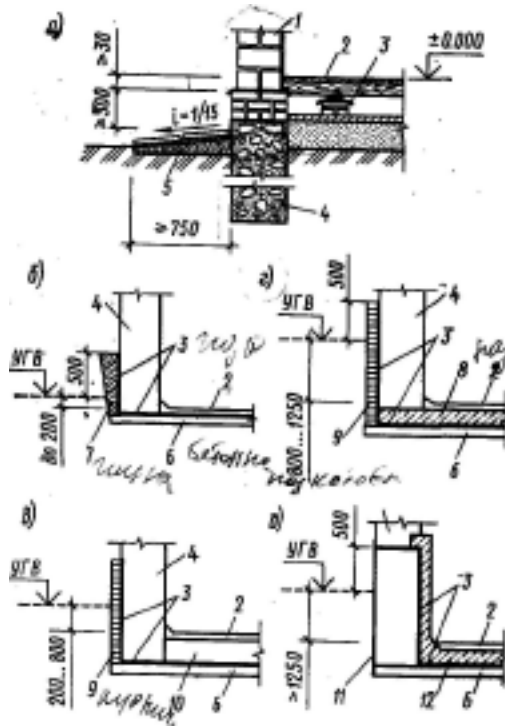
Защита элементов малоэтажных зданий от влаги грунтов:
